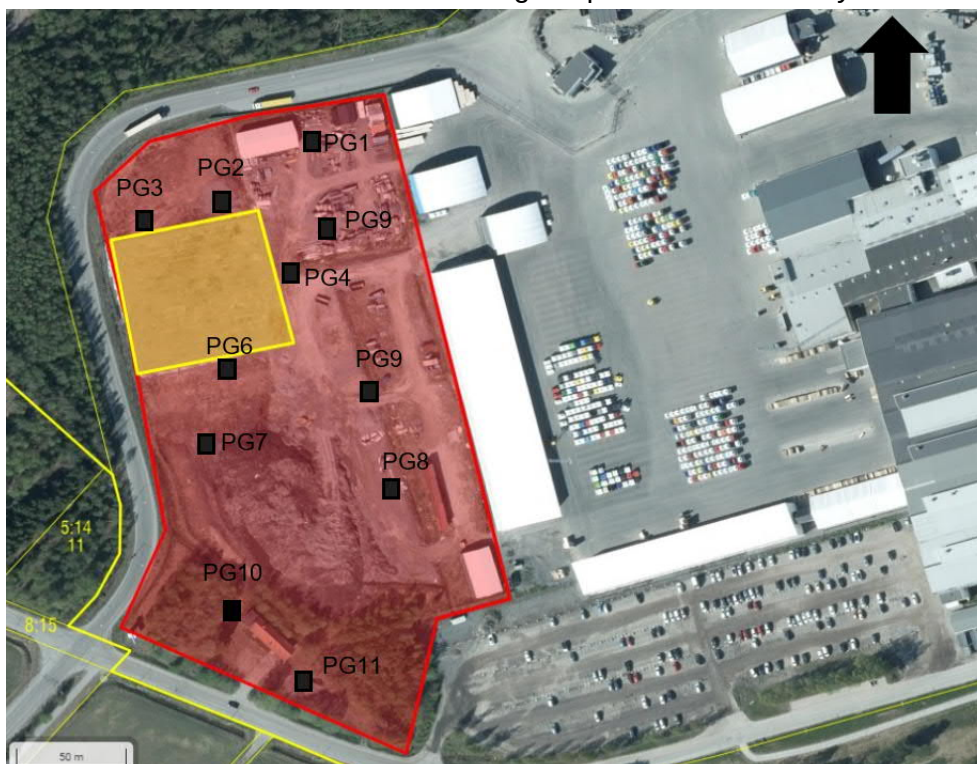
Röd markering är planerad plan, och gul markering är redan anlagd plan med geotextil och fyllningsmaterial. Provgroparnas ungefärliga läge ses i figuren.
